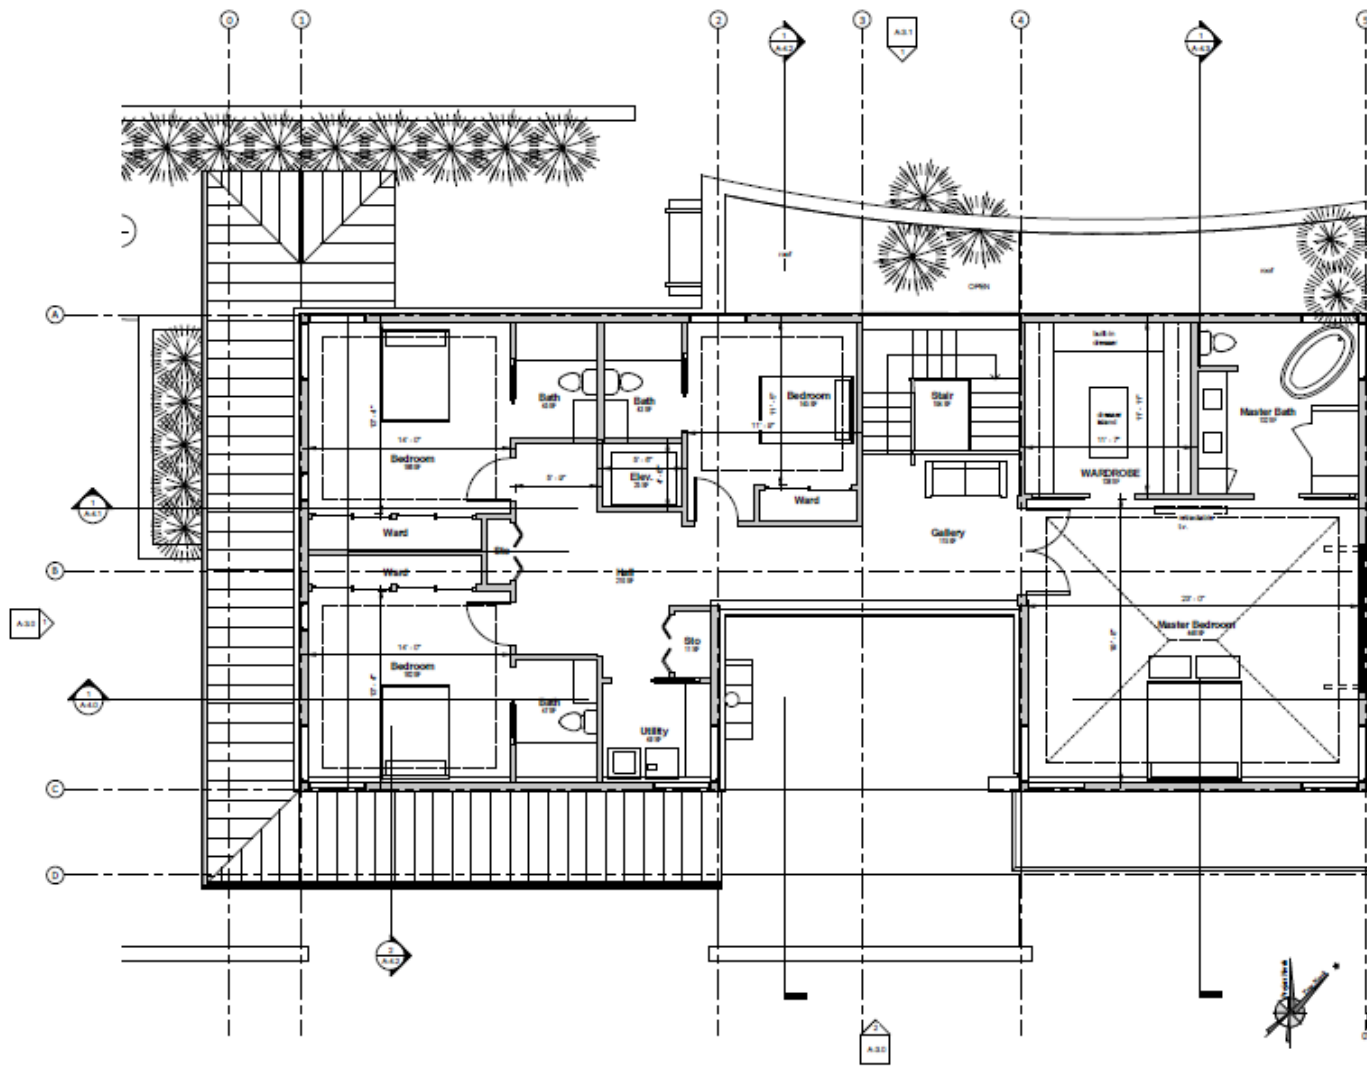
Planta de Primer Piso (Arquitectura)
